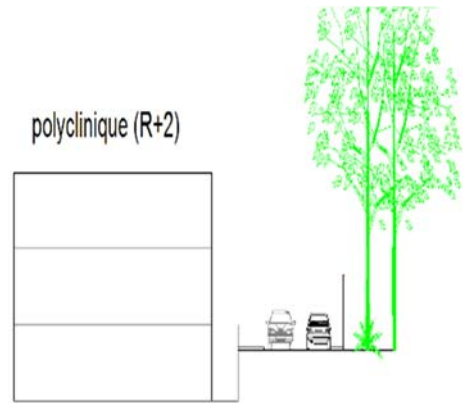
Coupe sur la voie de la daïra (Source : auteur)
